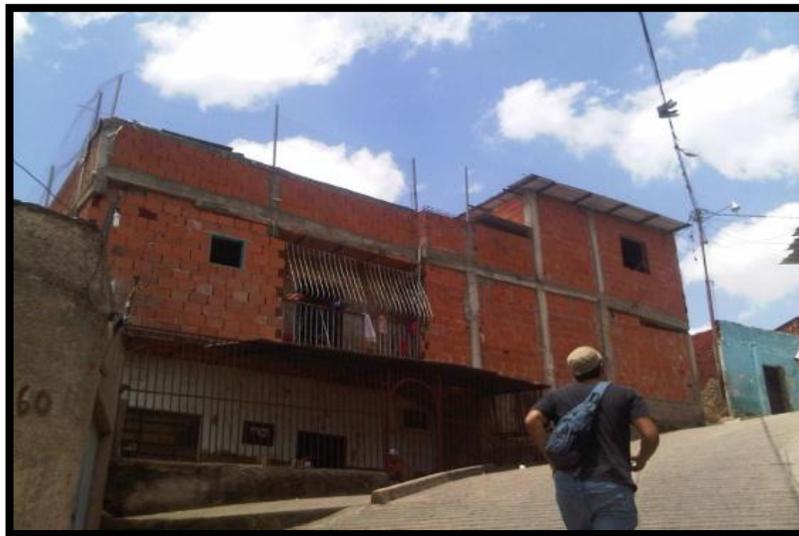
Vivienda tipo pórticos rellena con mampostería.
